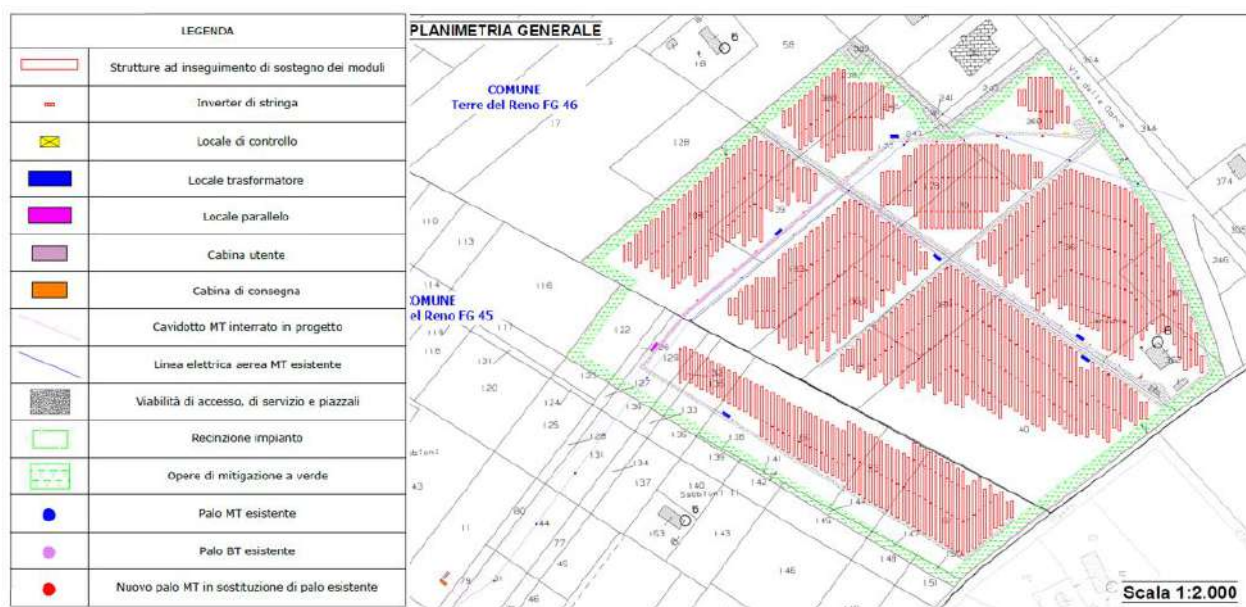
Planimetria generale con opere di mitigazione impianto FV “Le Donne”
